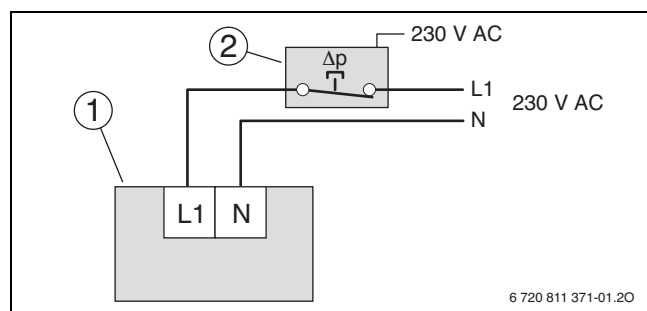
Collegamento del pressostato differenziale nel cavo elettrico
